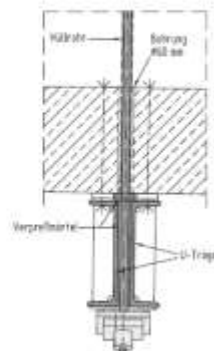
Querkraftverstärkung, Querschnitt und Details (Entwurfsplanung)
